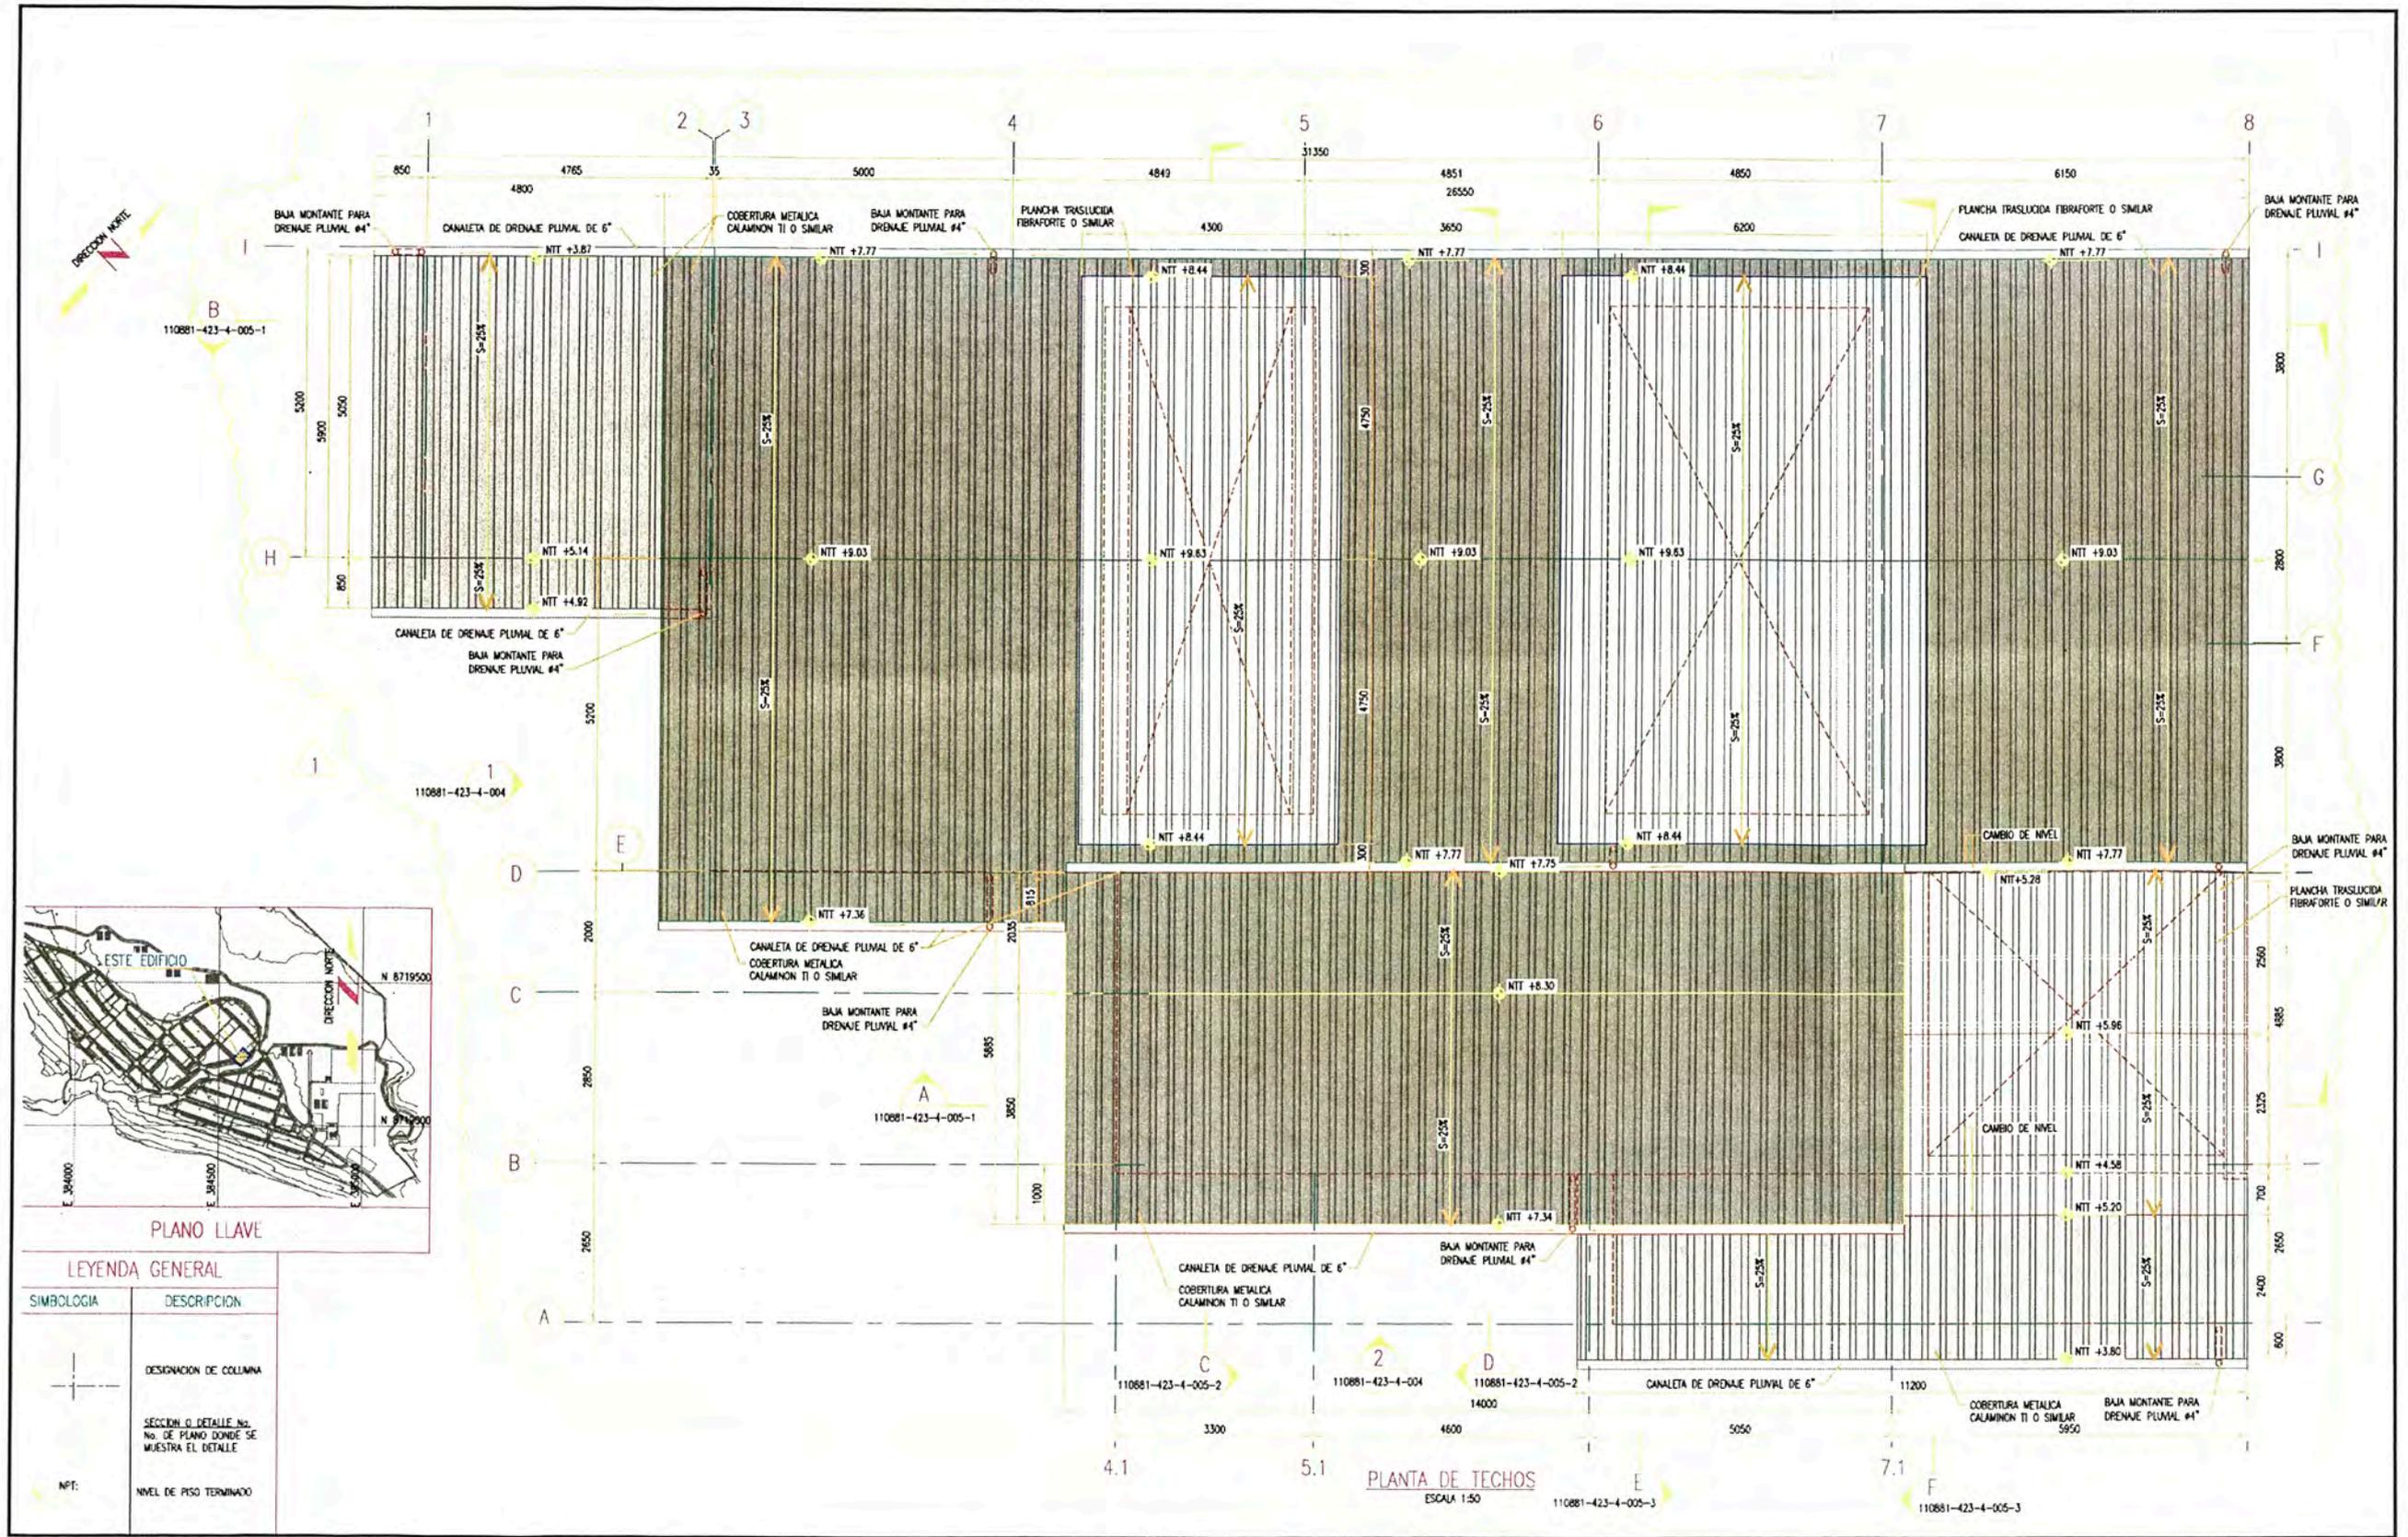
Plano de Arquitectura, cobertura de techo
